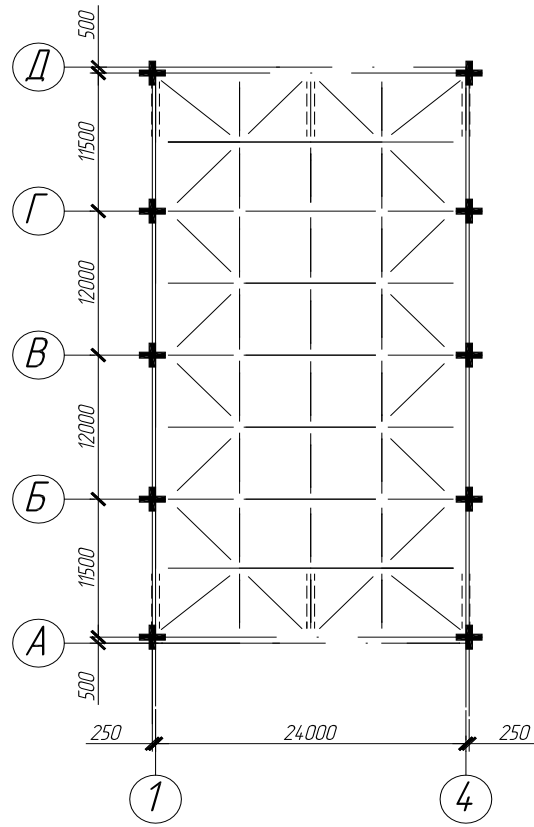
Горизонтальні зв'язки по верхньому поясу
